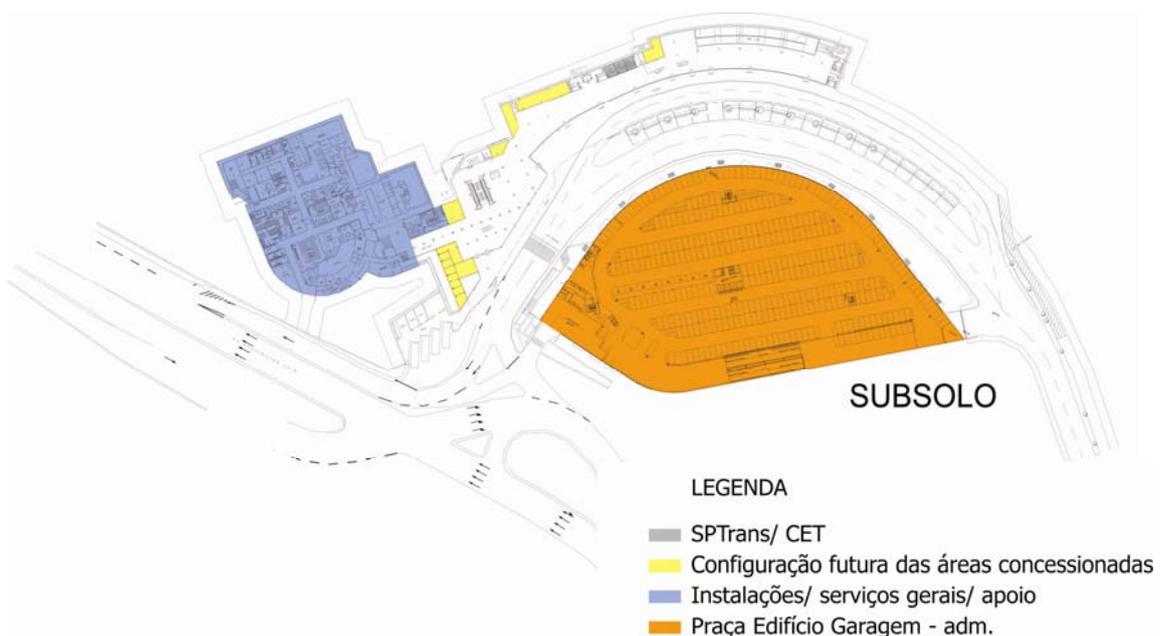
Planta do Subsolo. Fonte: INFRAERO, 2008.
